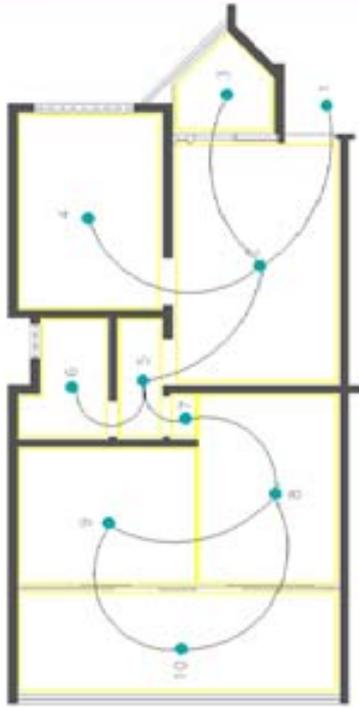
QRSW 2 – Bloco B5 – Sudoeste Econômico – Planta Original
